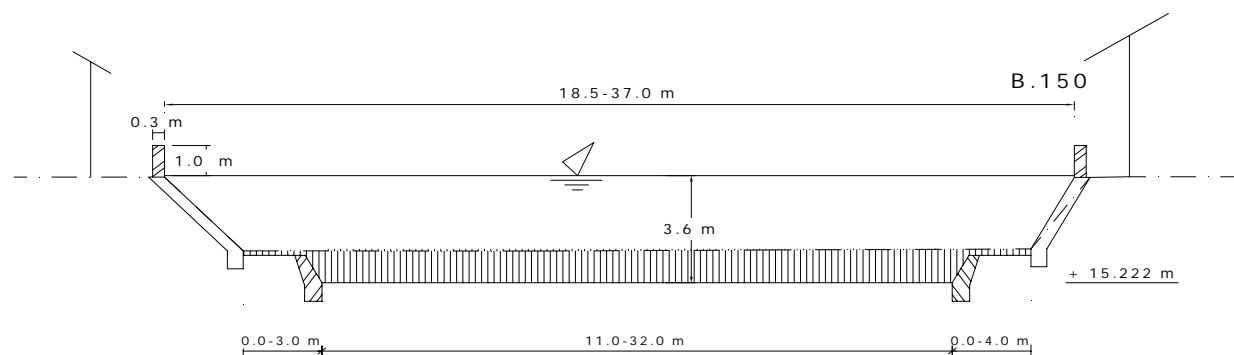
Disain Profil Memanjang untuk Sungai Badung
